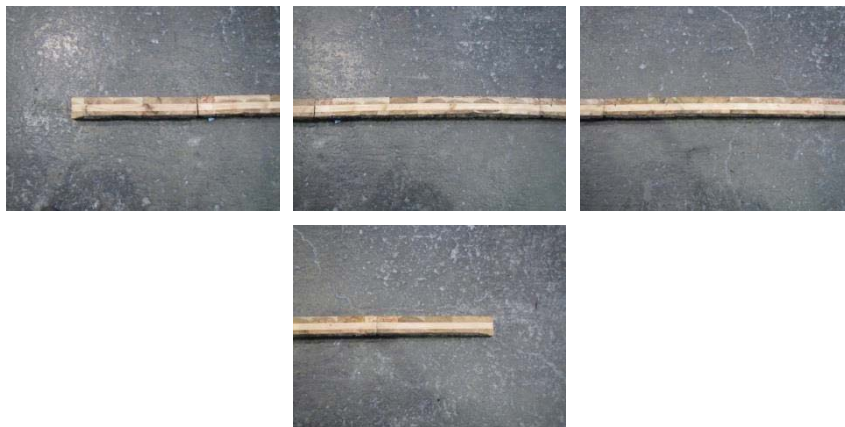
試験後の断面状況（断面Ⅱ）
